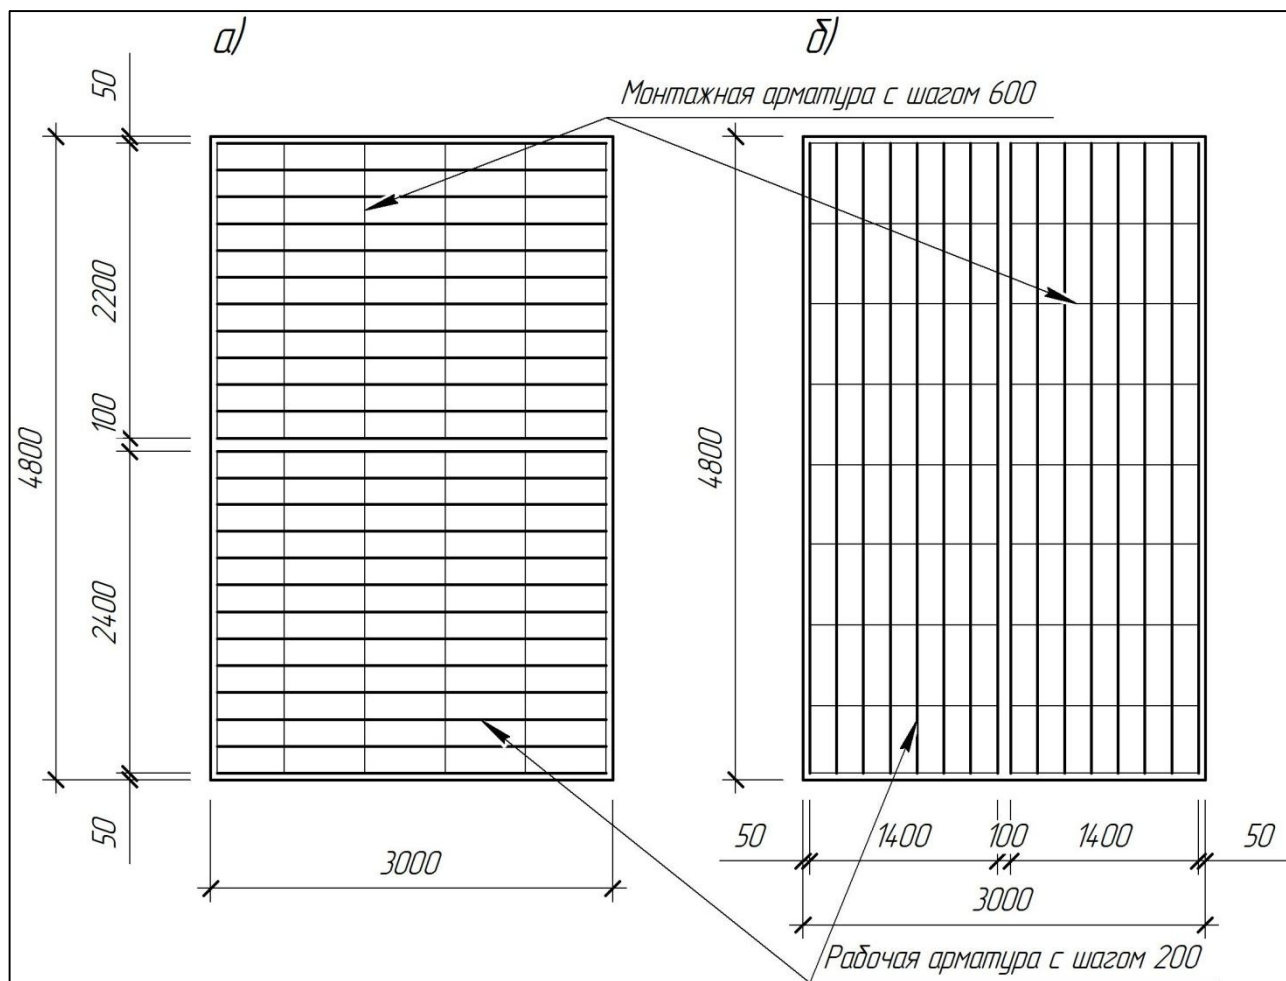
Схема армирования фундамента сварными унифицированными сетками:
